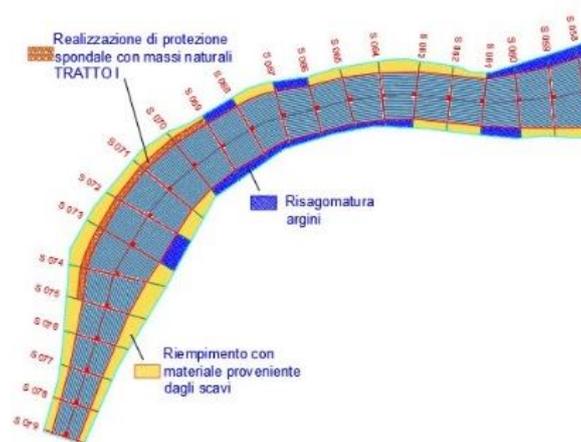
Fiume Lipuda – Planimetria con dettaglio 3 degli interventi di progetto
